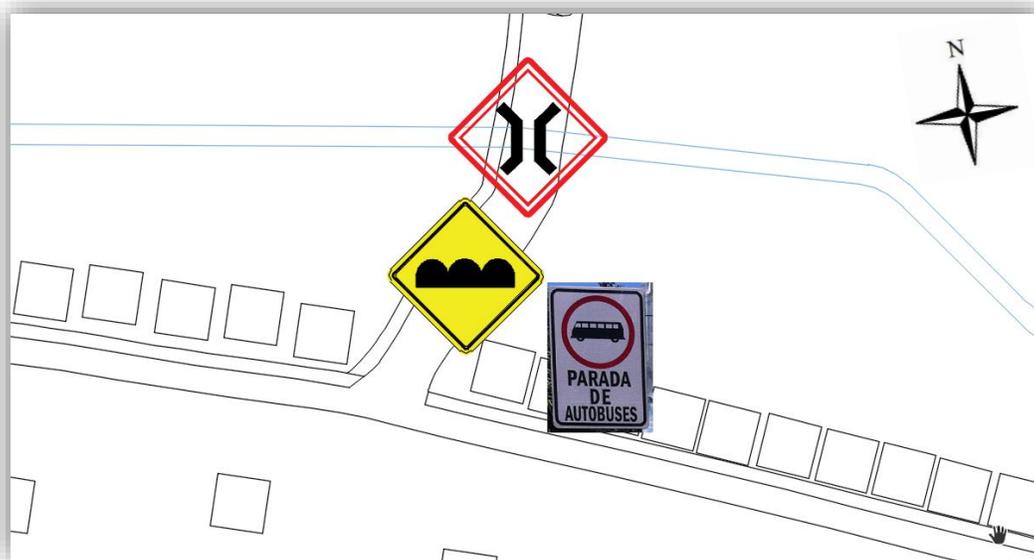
, Calle del Instituto y 5ª calle, Fuente: Propia
